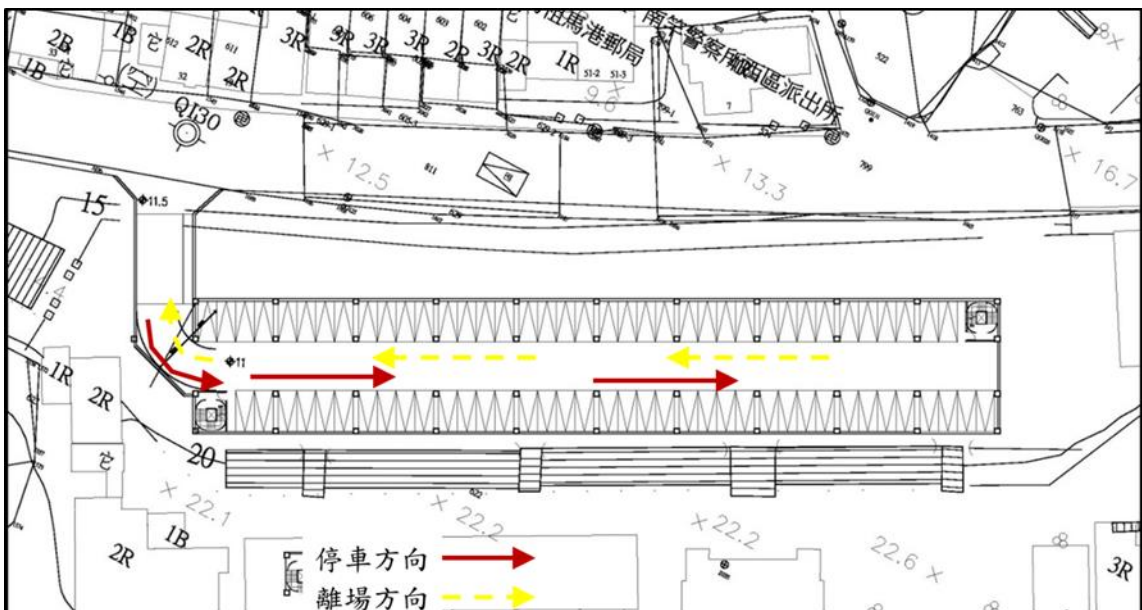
南竿中正國中公共地下停車場(B2)平面圖
